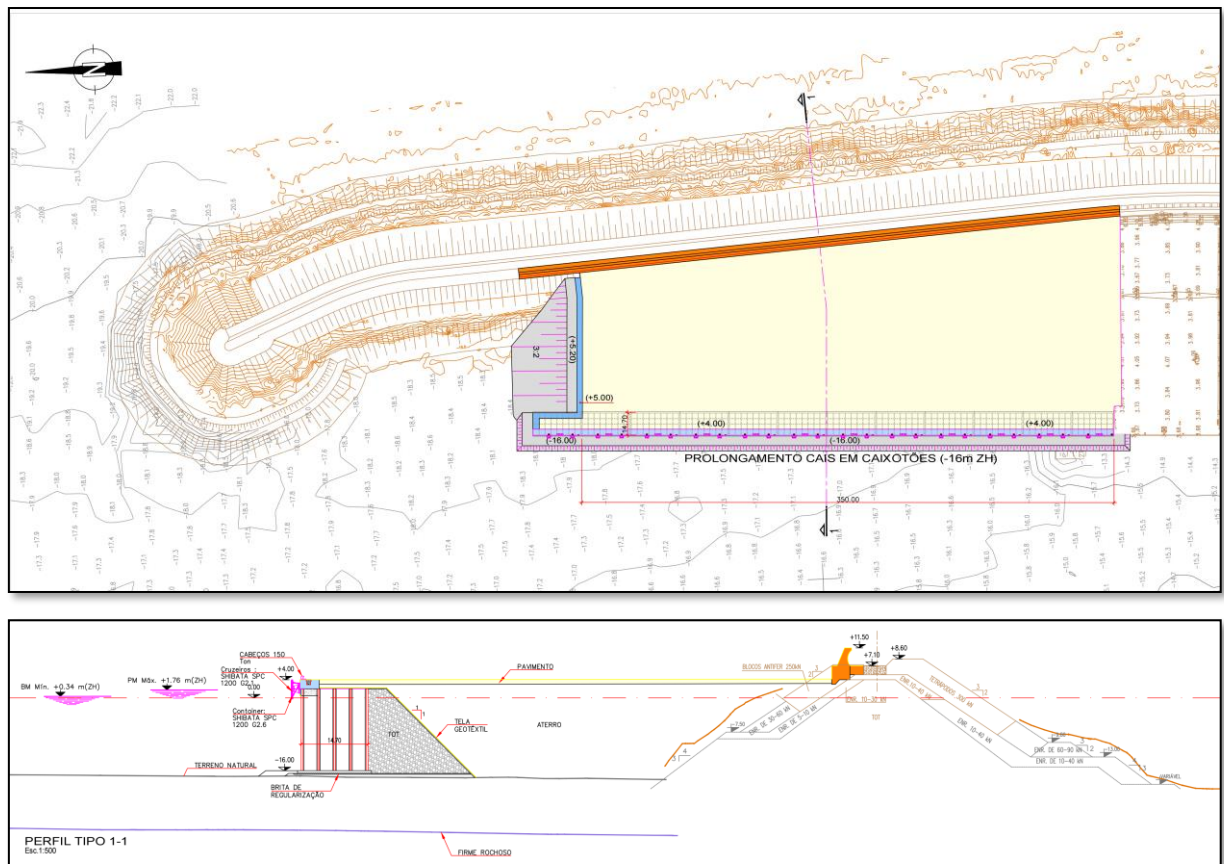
Prolongamento do cais existente à -12m(ZH) – SOLUÇÃO 3B (planta e perfil tipo)
